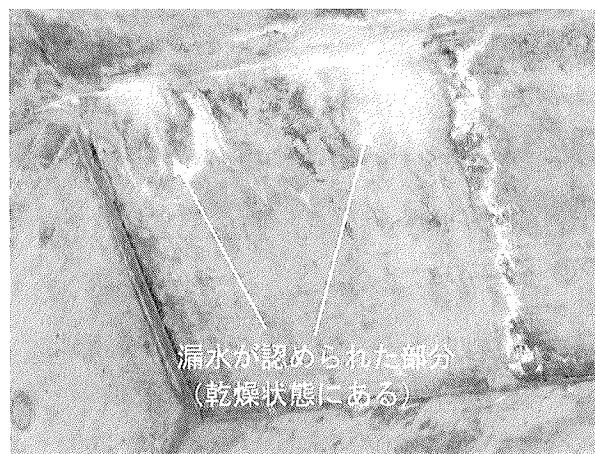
リフレッシュ・シャワー工法施工後の漏水状況
